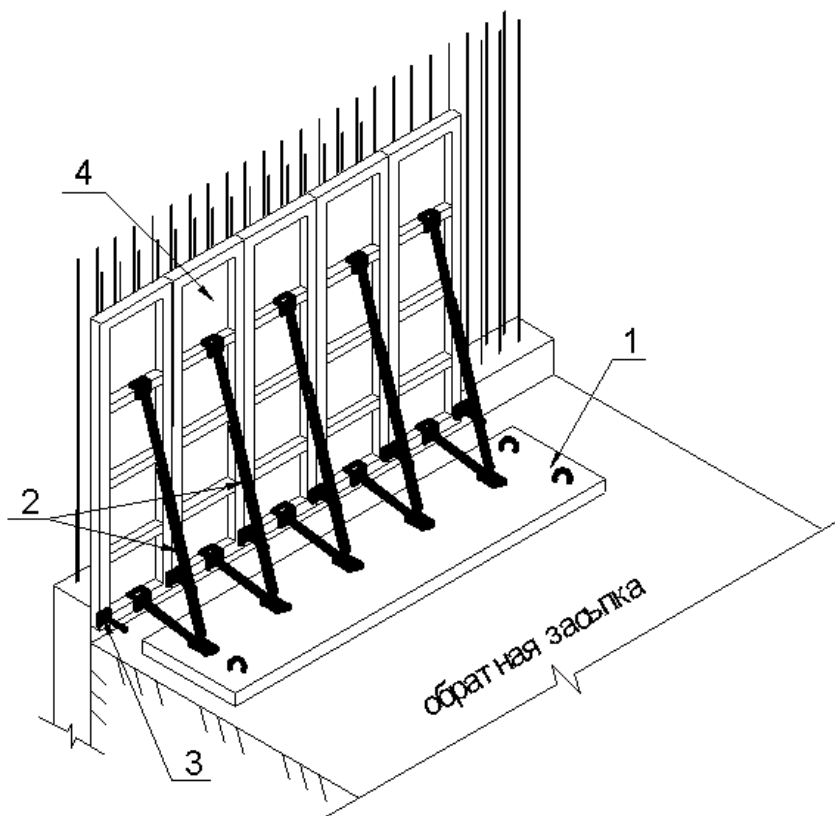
Установка щитов опалубки со стороны обратной засыпки: 1 – плита ПТП, 2 – раскосы, 3 – стяжные болты, 4 – щиты опалубки.
